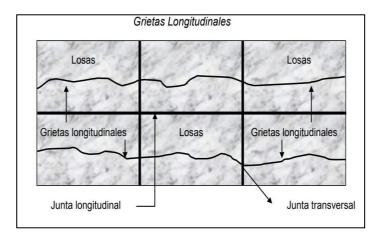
Falla por fisura longitudinal de Pavimento Rígido
